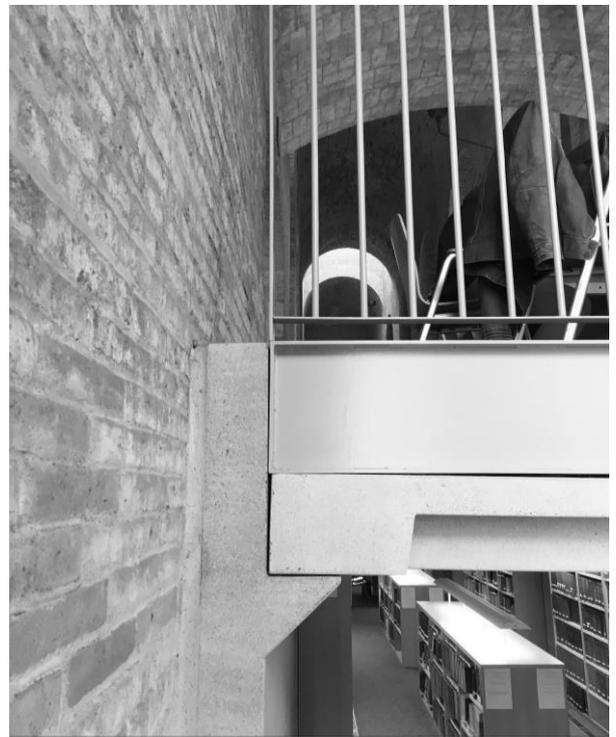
CLOTET-PARICIO, Detalle muro y entrepiso
